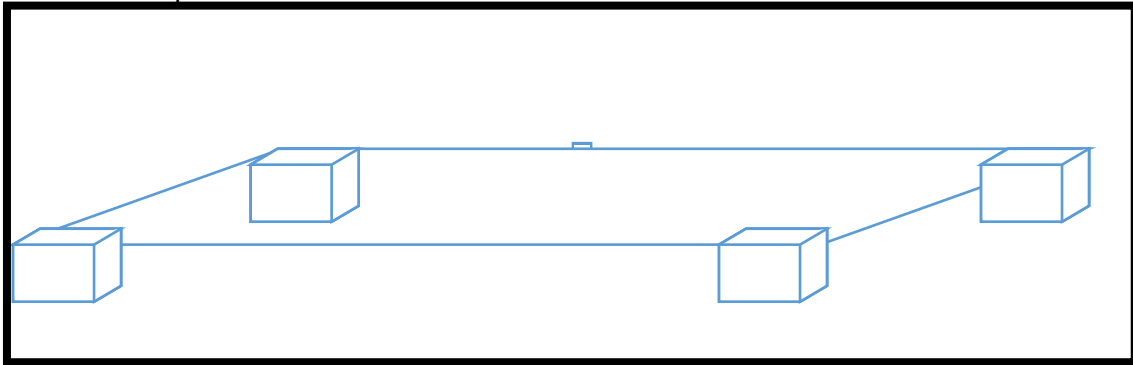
Disposición de fundaciones para viviendas modulares.
